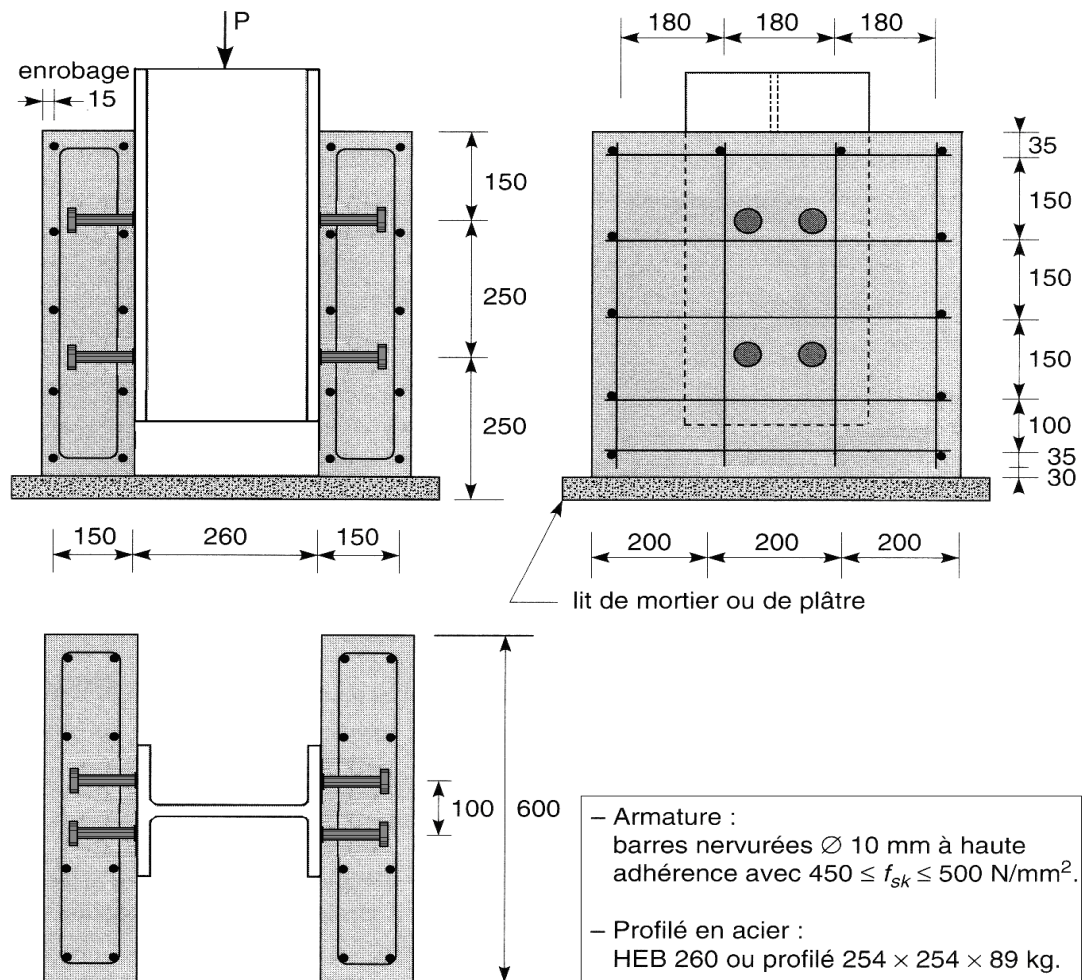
Dispositif d'essai de push-out sur des goujons à tête
